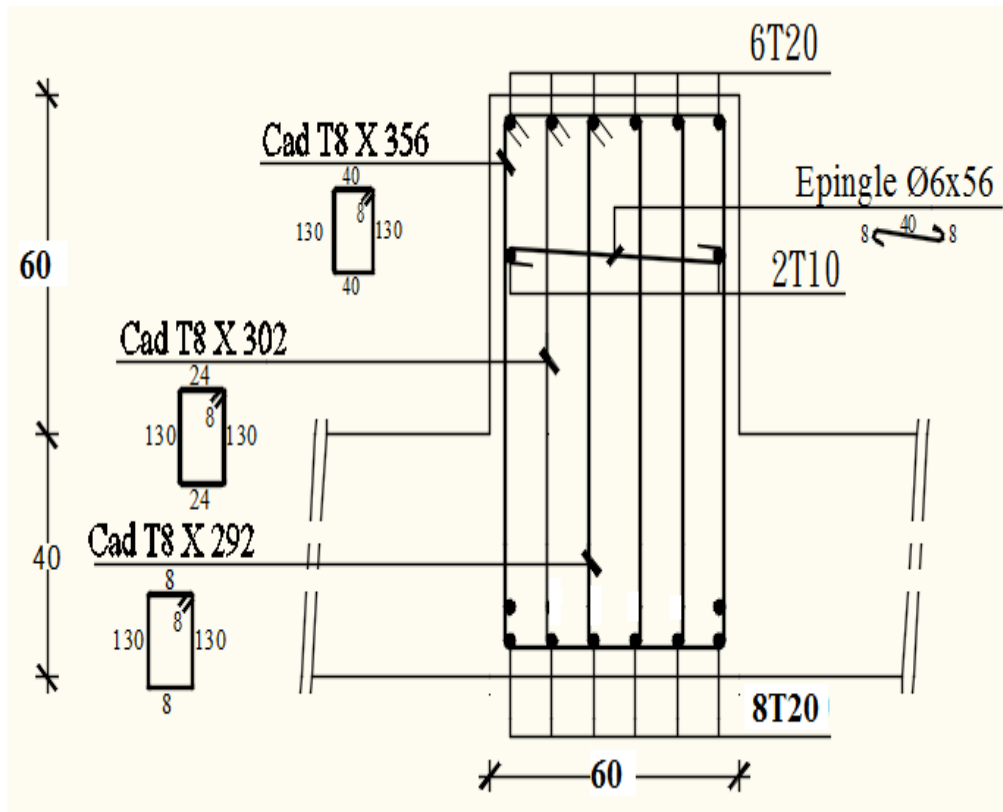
dessin de ferrailage d'une poutre secondaire en appuis.
